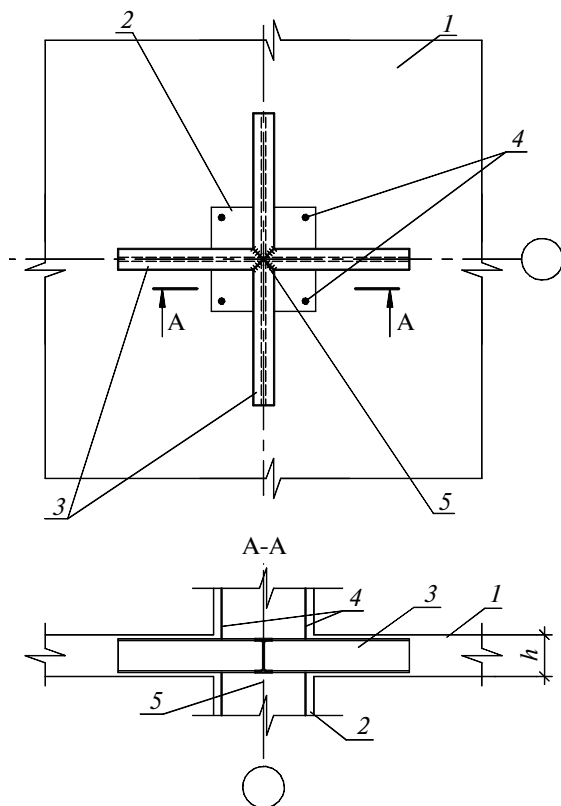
Скрытая консоль в опорной зоне плоской плиты перекрытия:
